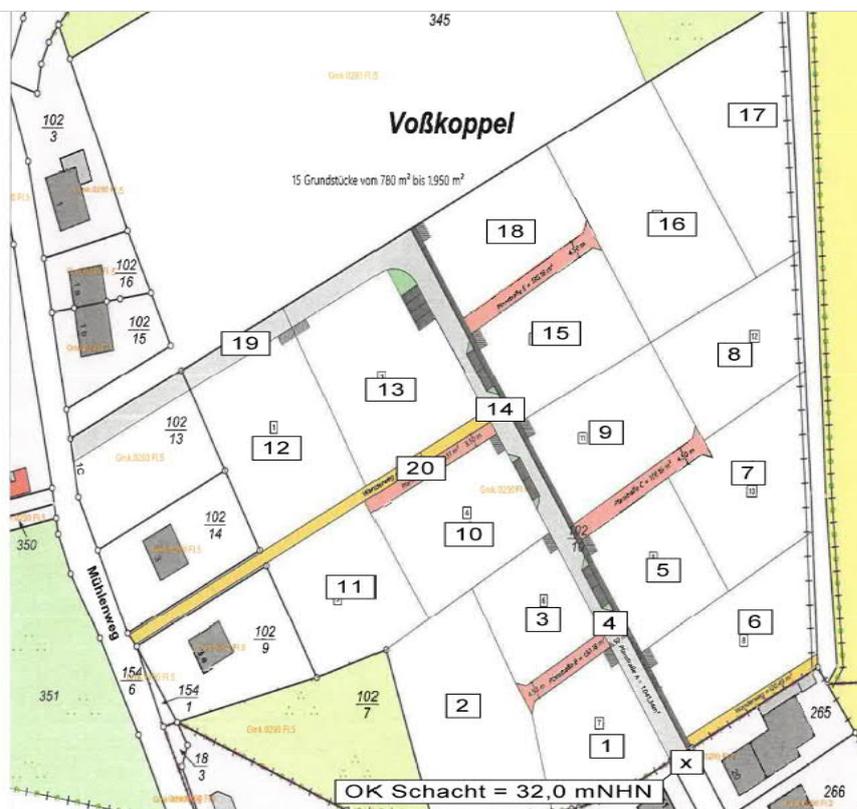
Lage der durchgeführten Kleinrammbohrungen im Plangebiet
